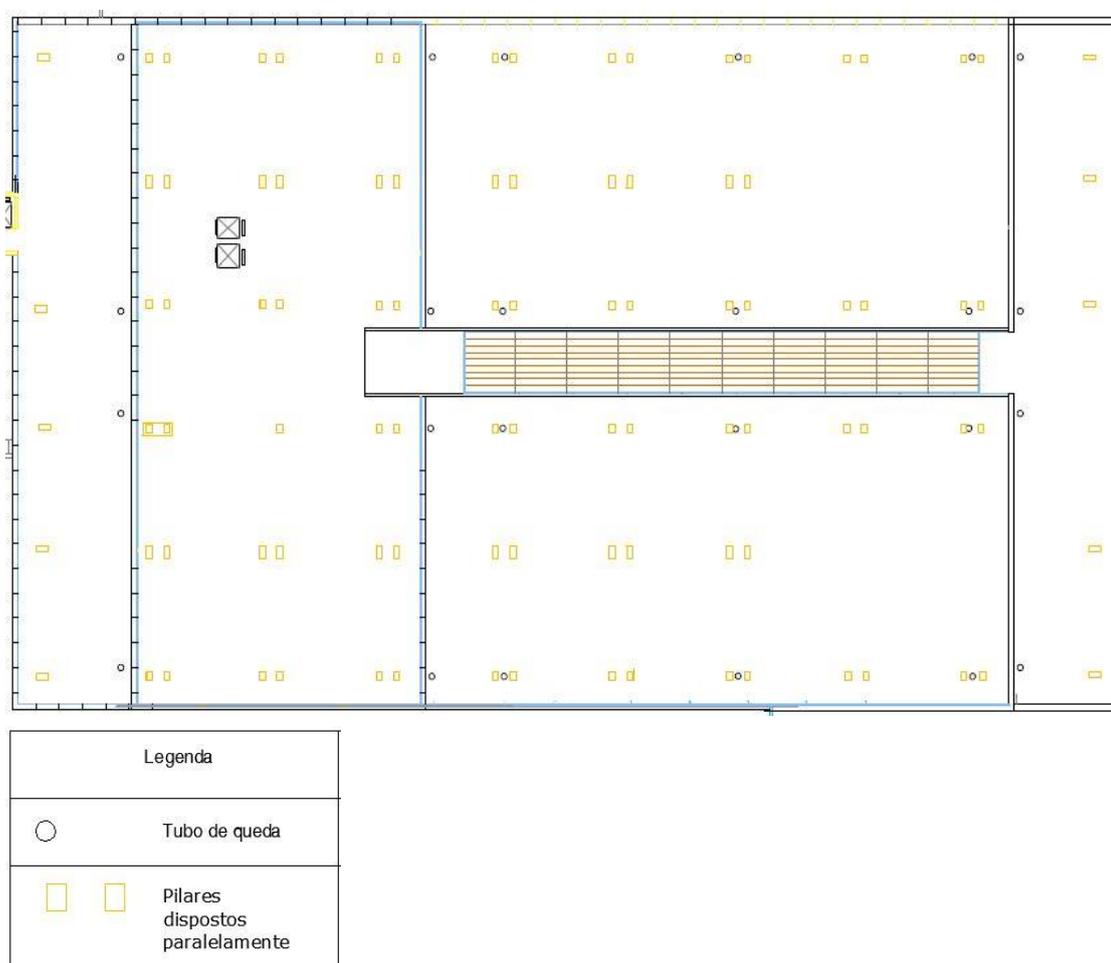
Planta de cobertura do edifício (Anexo 6) [Fonte: Documentação ARSLVT,IP].
